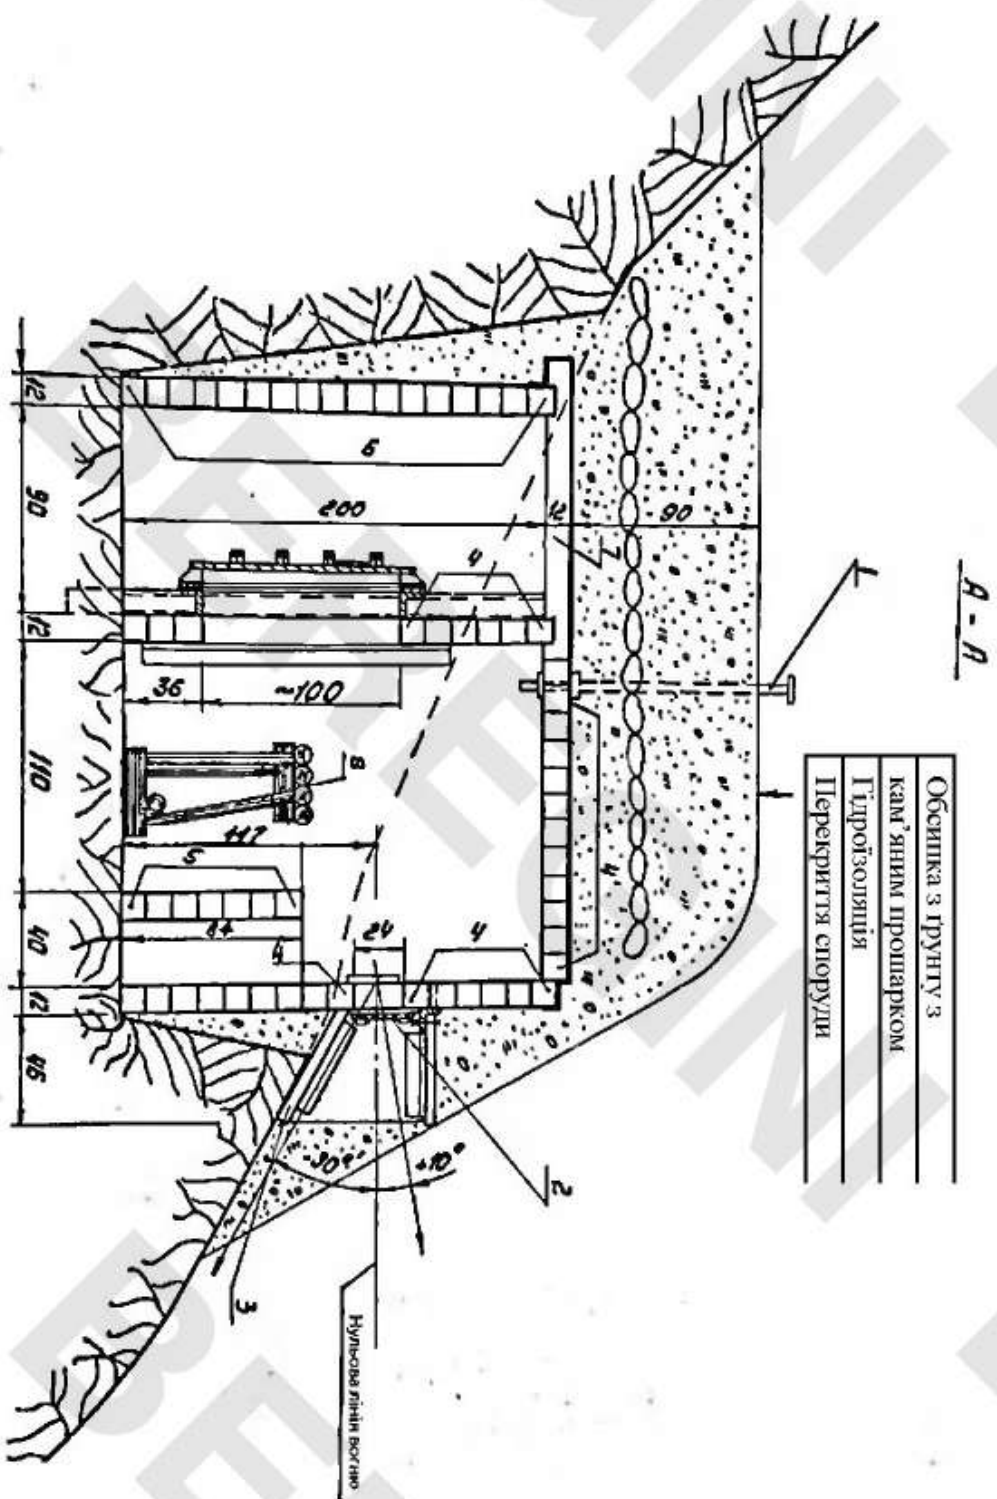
Кулеметна споруда із залізобетонних елементів (розріз):
